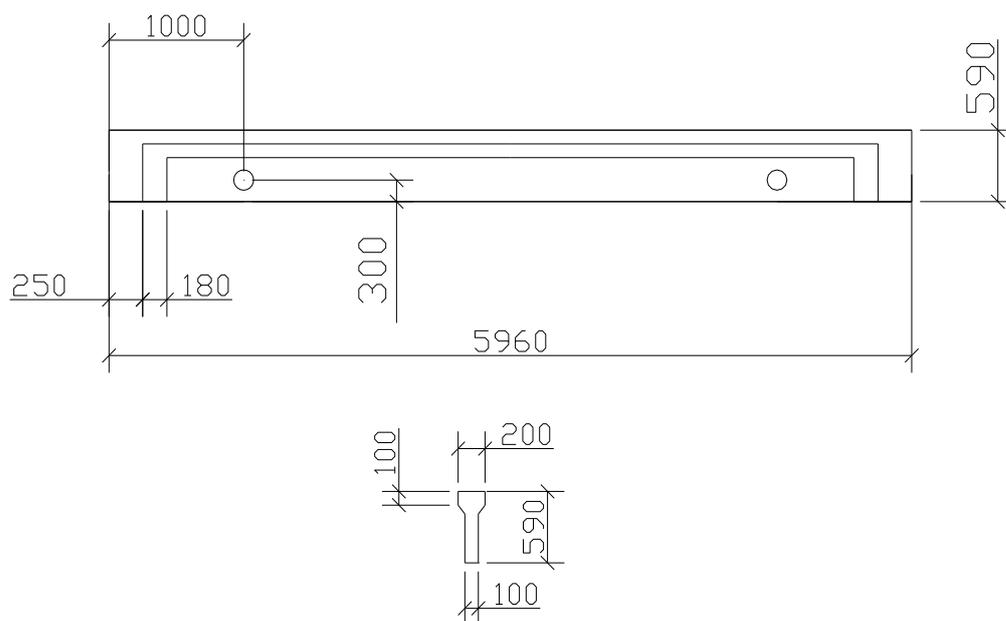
Залізобетонна ґратчаста балка ЗБДР18-4AV.
